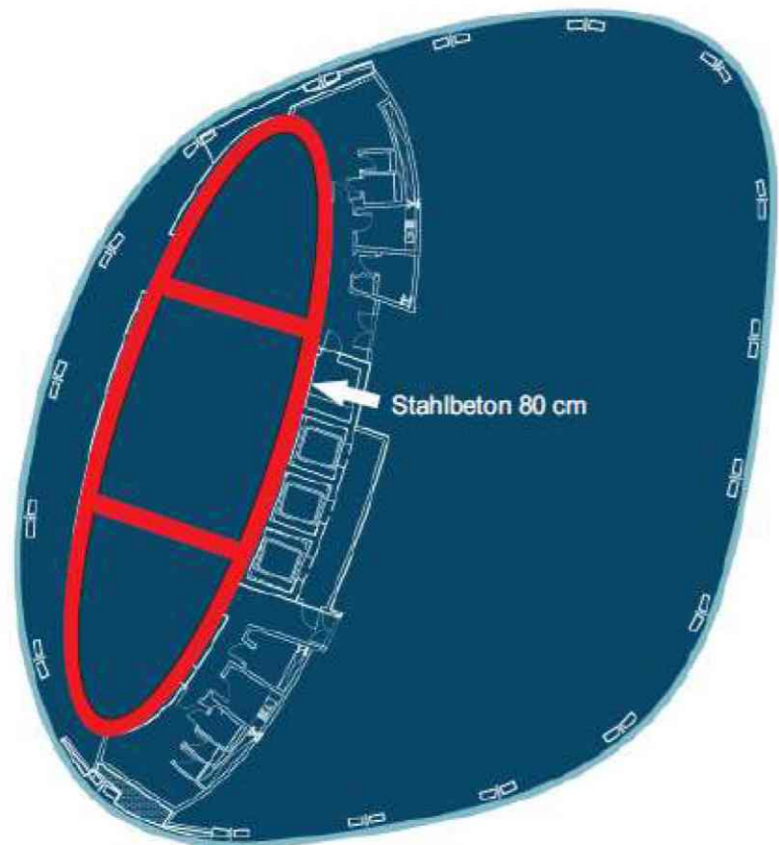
Der Grundriss des Ortbetonkerns ist durch einen elliptischen Grundriss gekennzeichnet und eine Vielzahl an Schächten gekennzeichnet.
